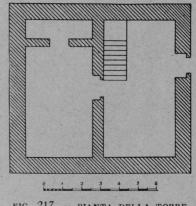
PIANTA DELLA TORRE DI \* VÒILA.
